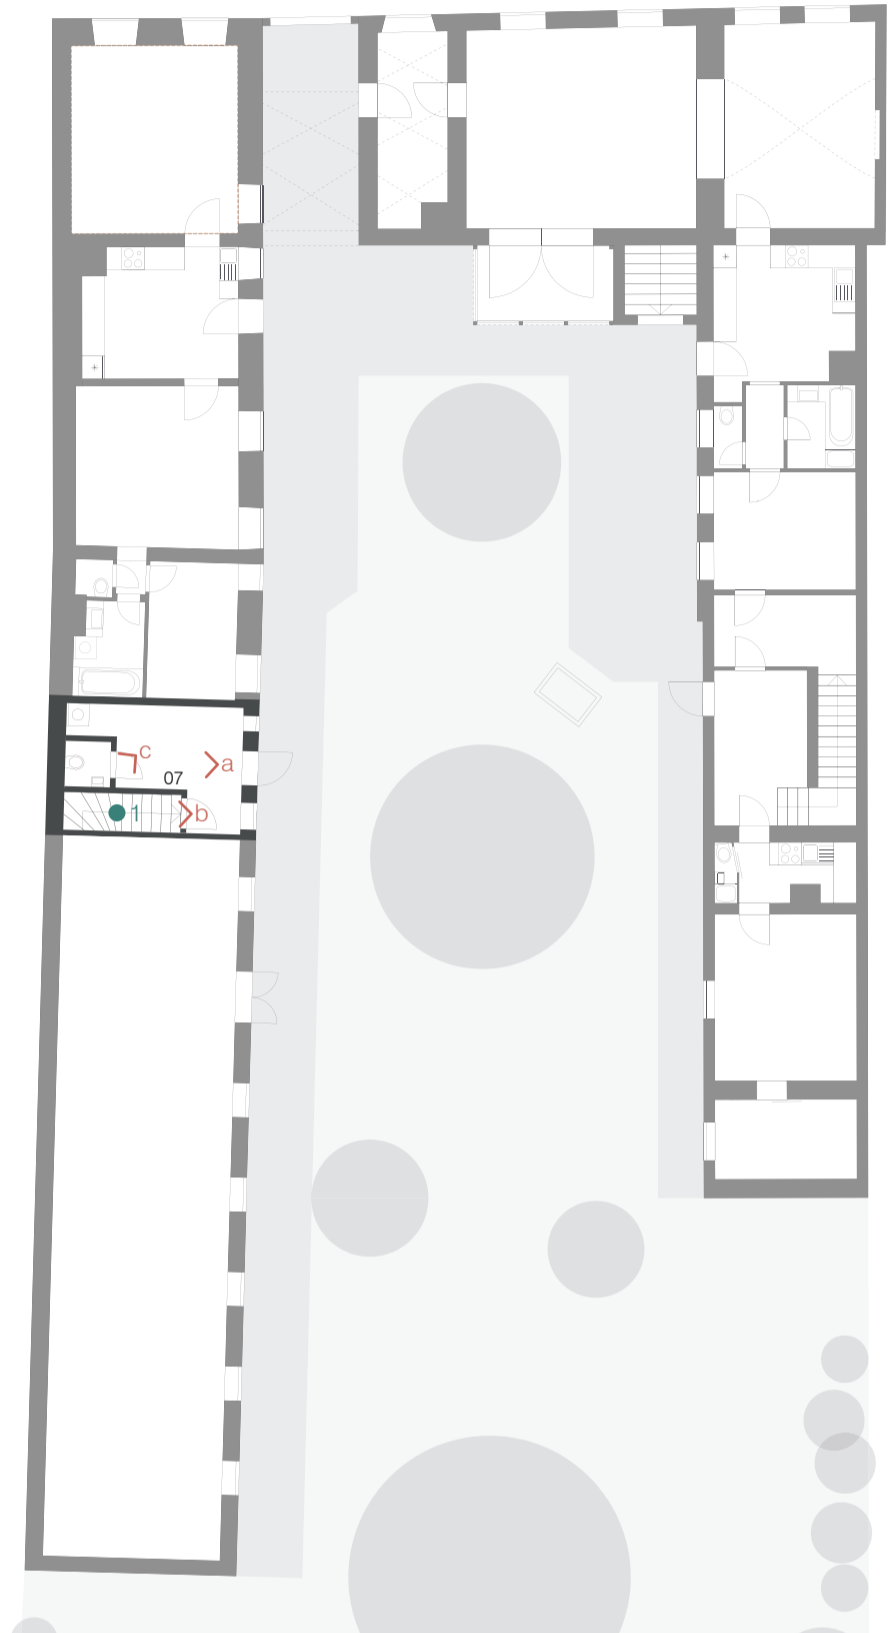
Grundriss Erdgeschoß | M 1:200 | Raum 07
